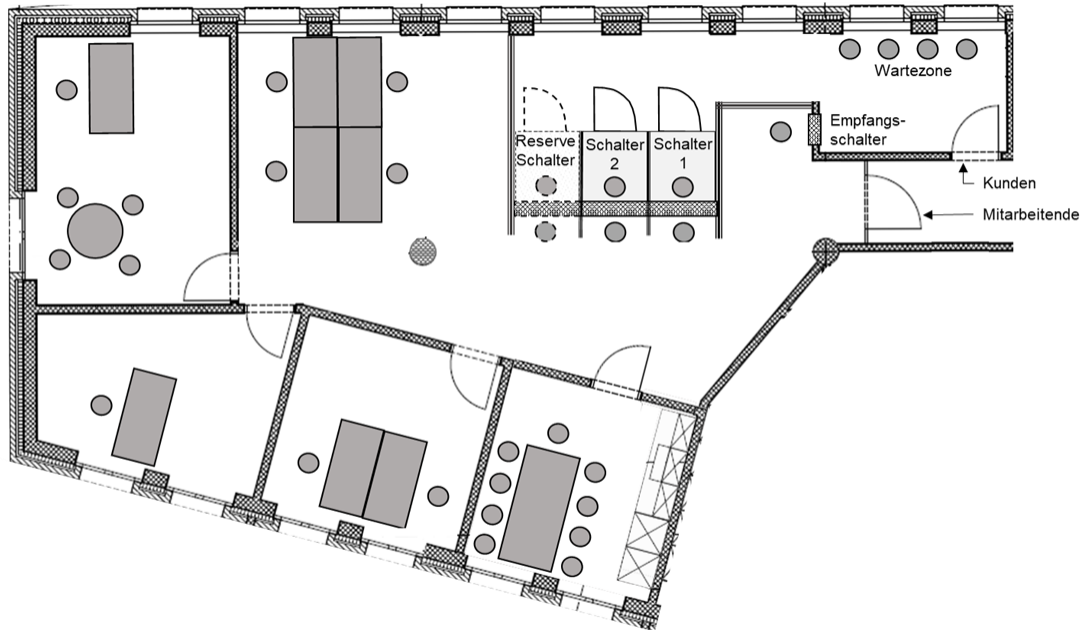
Projektplan Büro- und Kundenzonen Betriebsamt
